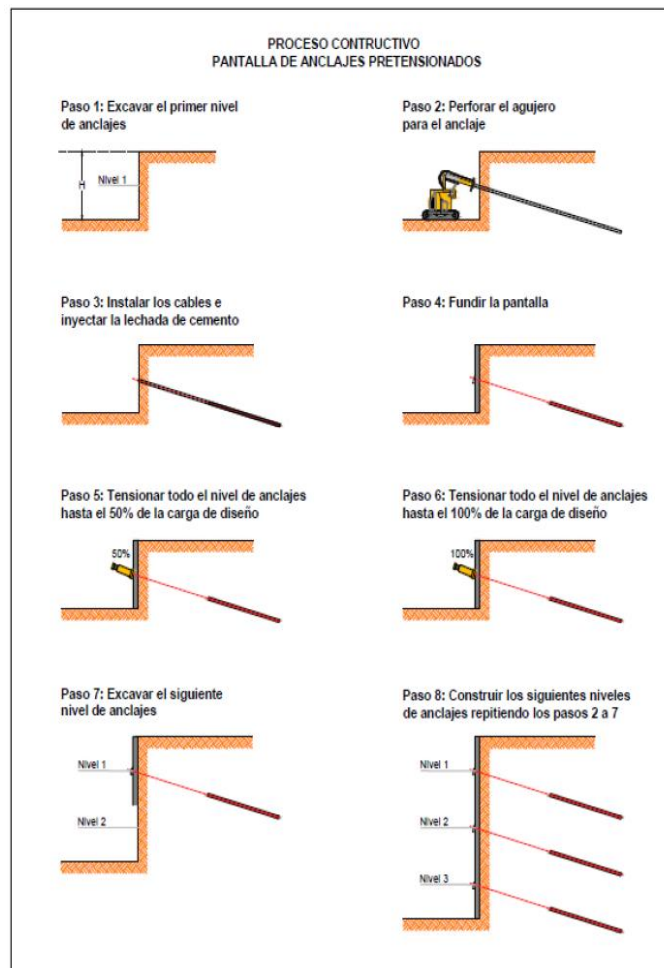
Esquema Perfil 1, pantalla anclada.
